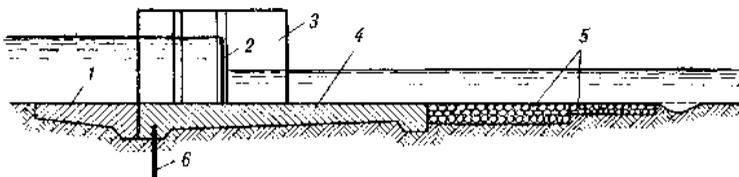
Схема плотины с флютбетом: 1 – понур; 2 – затвор; 3 – бык; 4 – флютбет; 5 – рисберма; 6 – шпунт
